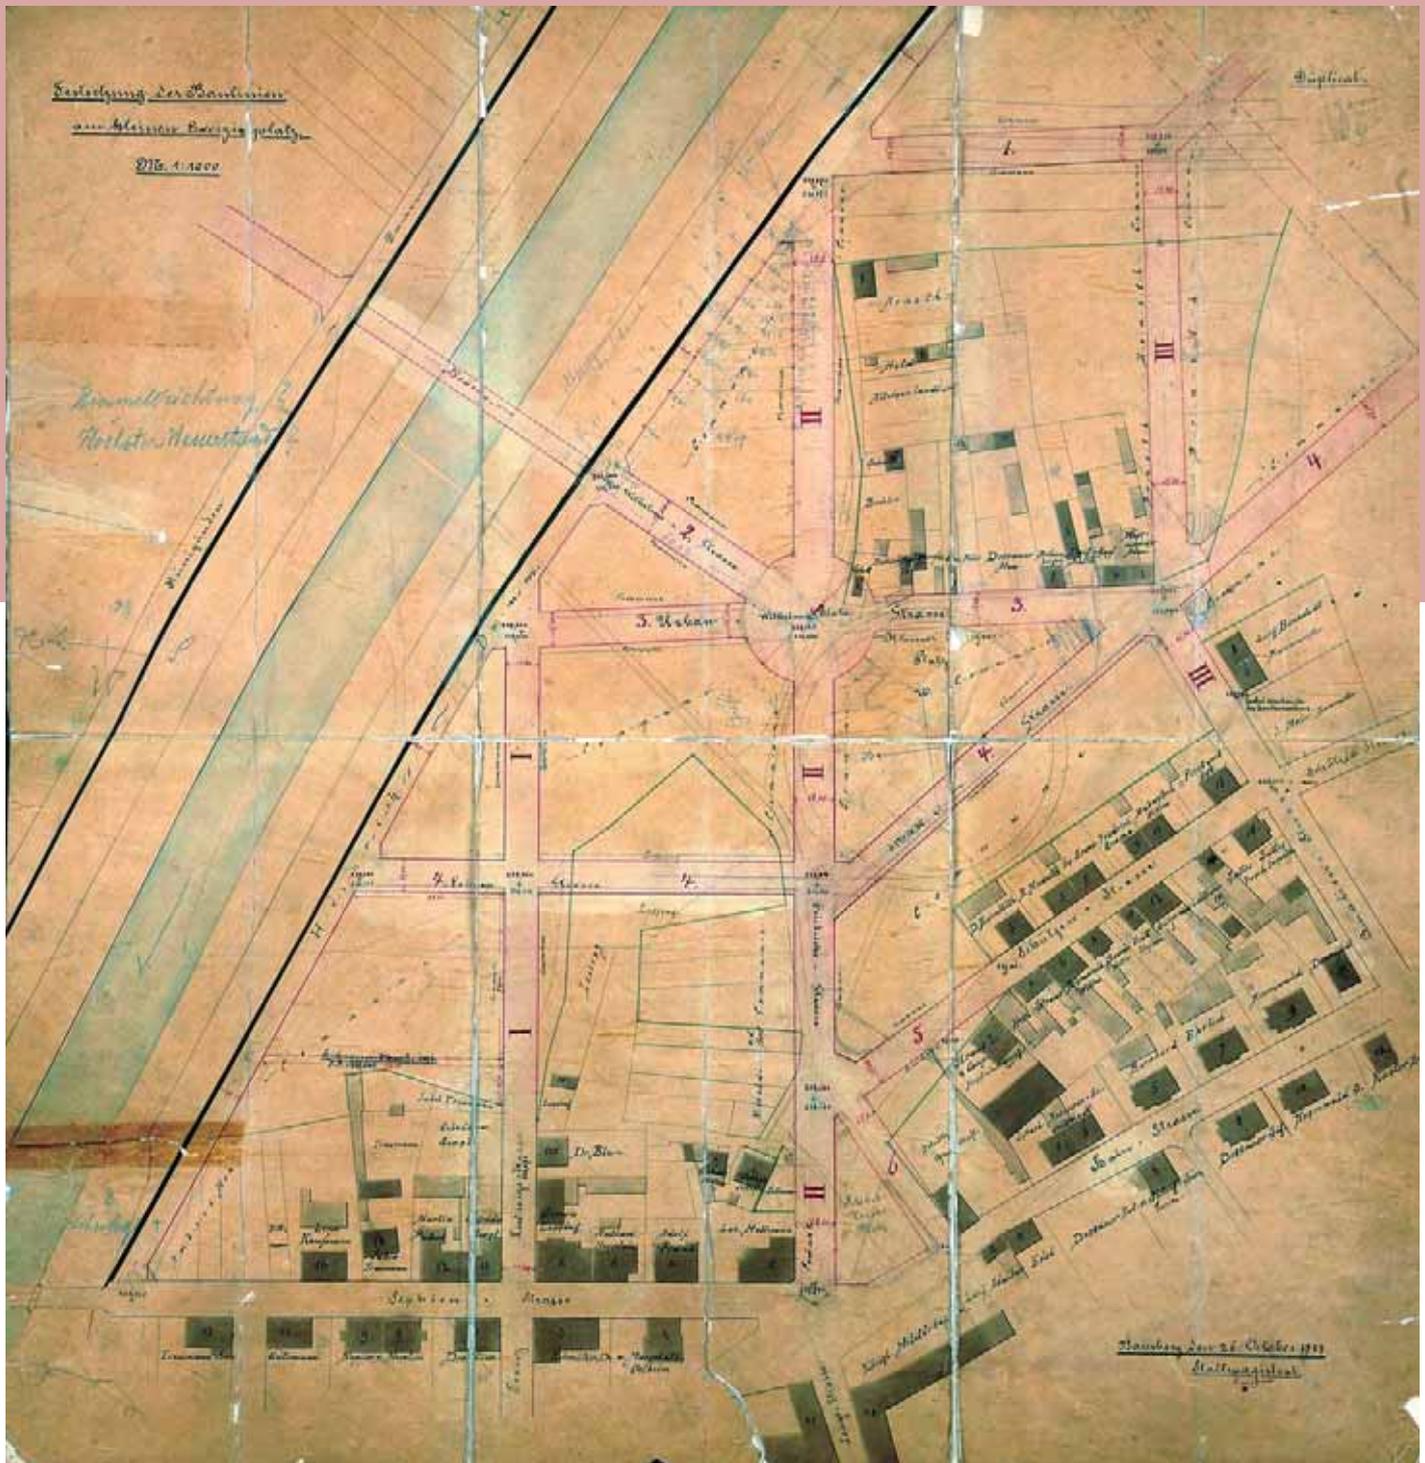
Baulinienplan 68 A für den Wilhelmsplatz und Umgebung, Stadtbaurat Lindner, 1888
